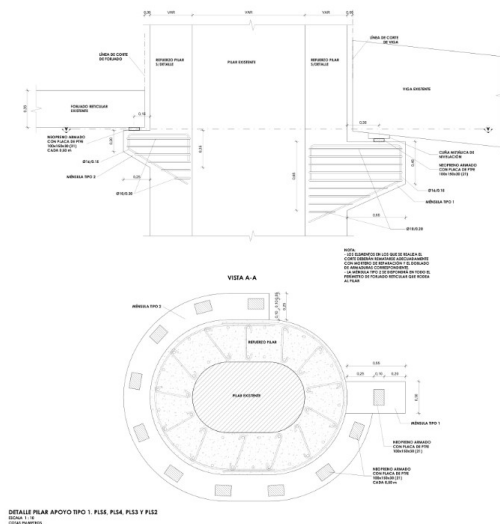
Alzado y planta pilar reforzado y apoyo de forjado
